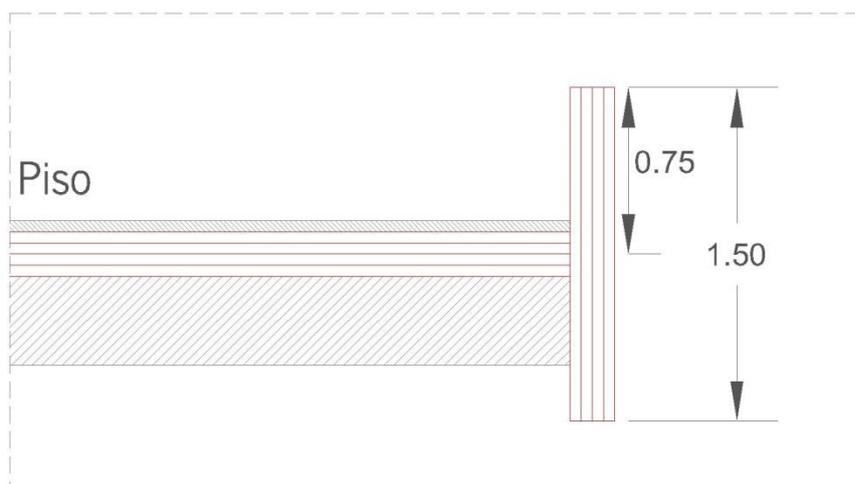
Colocação da Viga de MLCC a Eixo da Laje Estrutural
